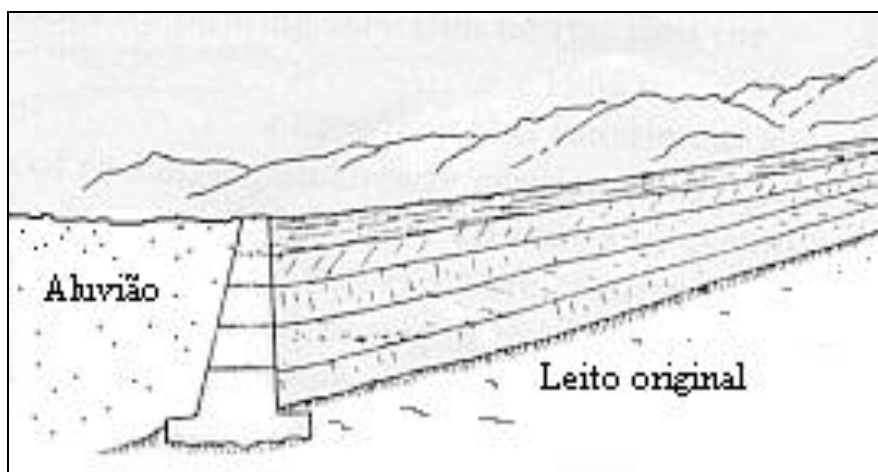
Esboço de uma barragem de assoreamento construída por etapas de construção e assoreamento, adaptado de SILVA (1998).
